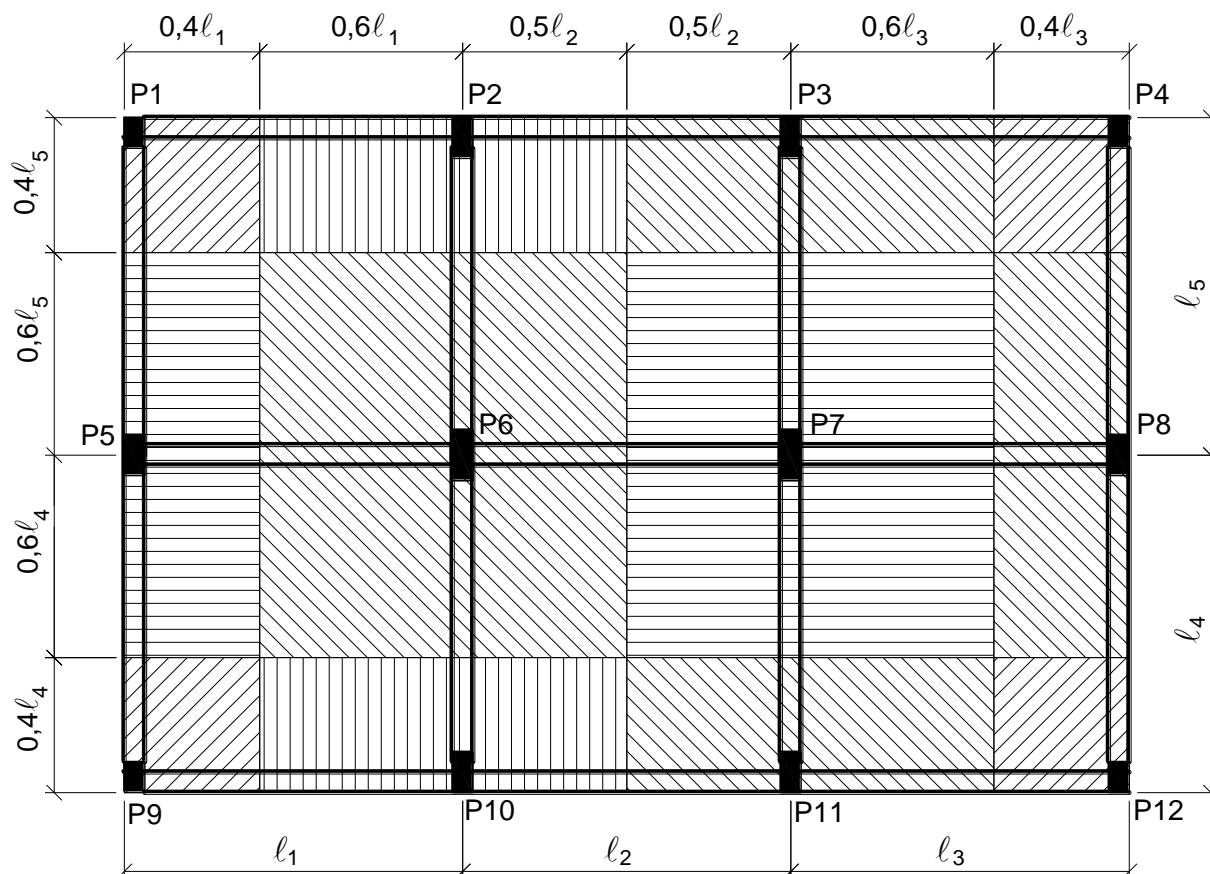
Processo simplificado para determinação da área de influência dos pilares.
